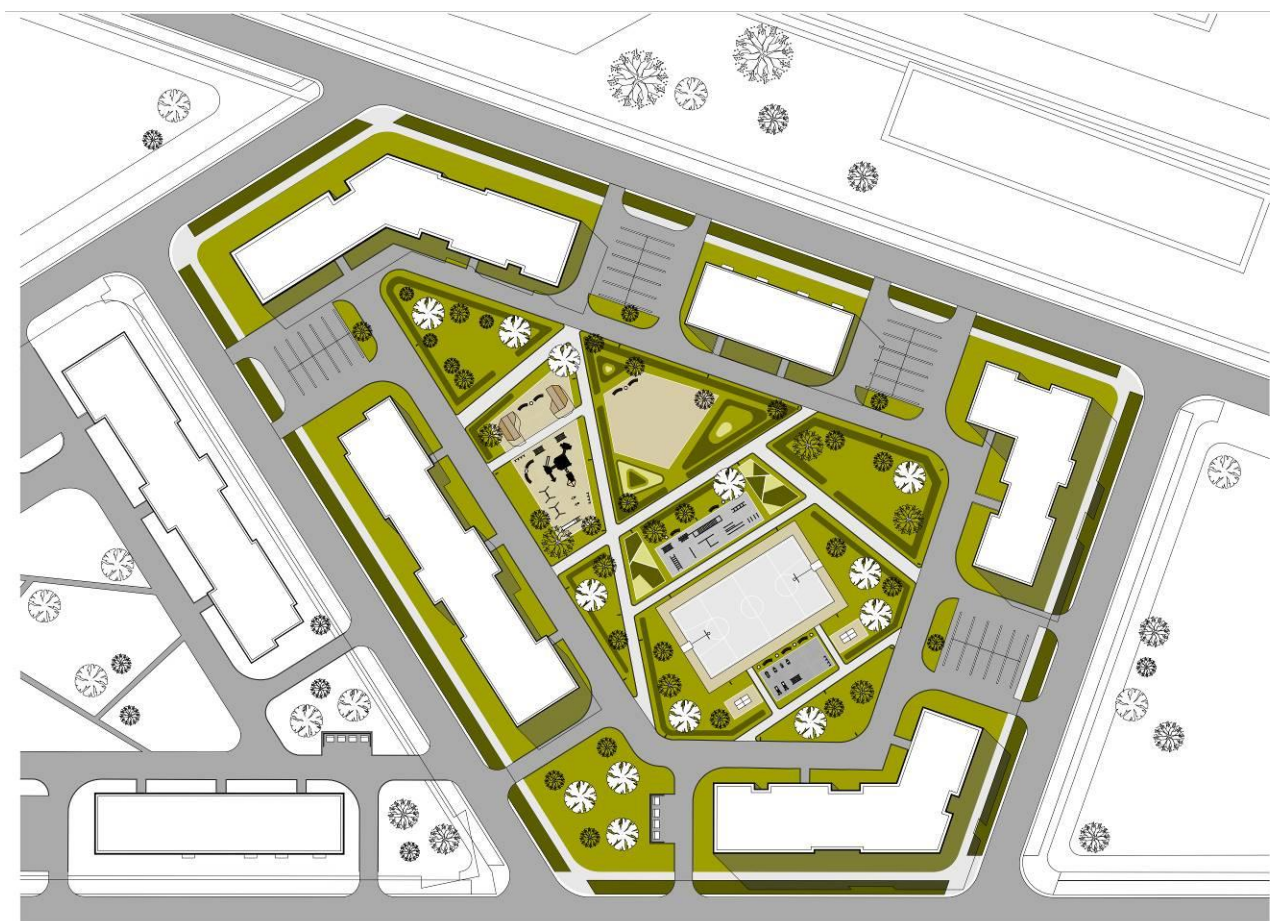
Фрагмент генерального плана с секционным домом средней этажности
